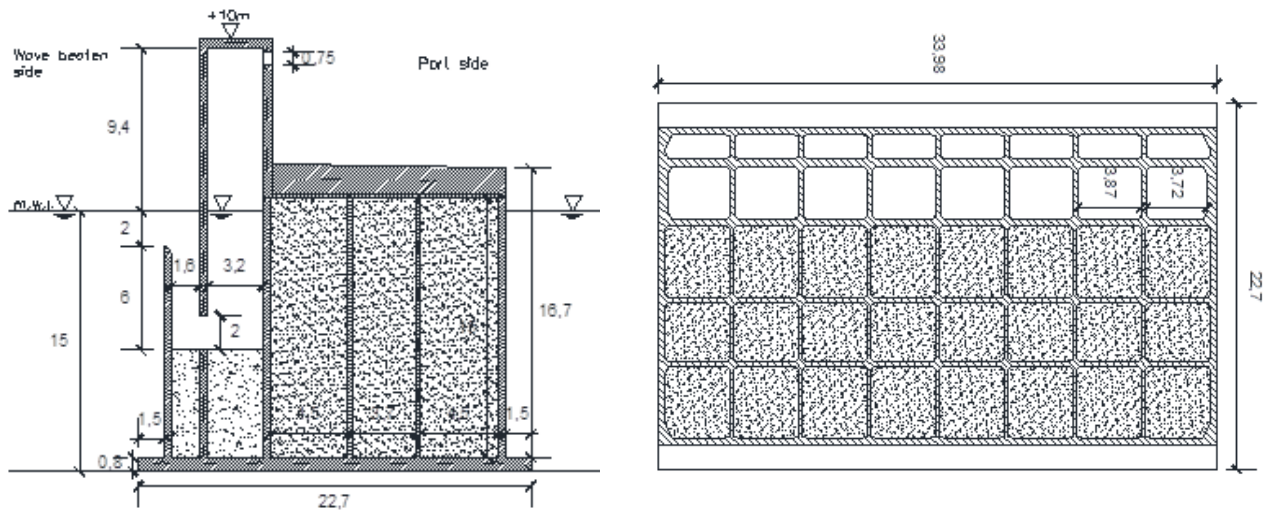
Sezione verticale e pianta dei cassoni REWEC3 presso il Porto di Civitavecchia.
